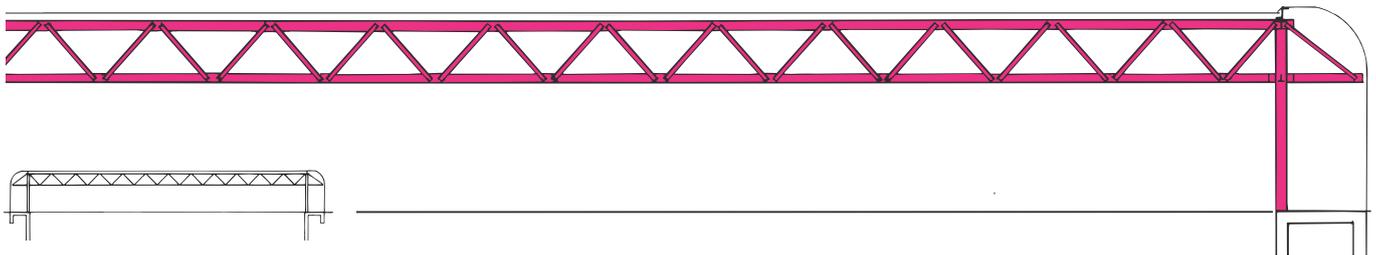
Binder als zweigurtiger Fachwerkträger, Sporthalle Notre Dame, Spannweite 36,60 m
